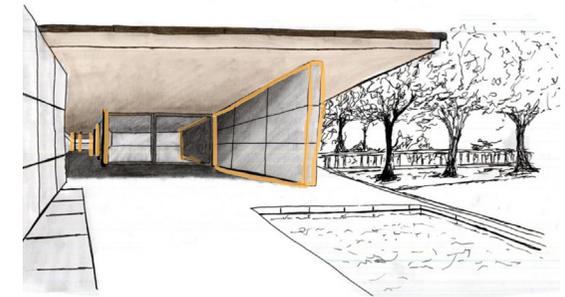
Croqui Pavilhão de Barcelona, (1928-29), Mies Van der Rohe - destaque para os elementos Pilar e Laje
